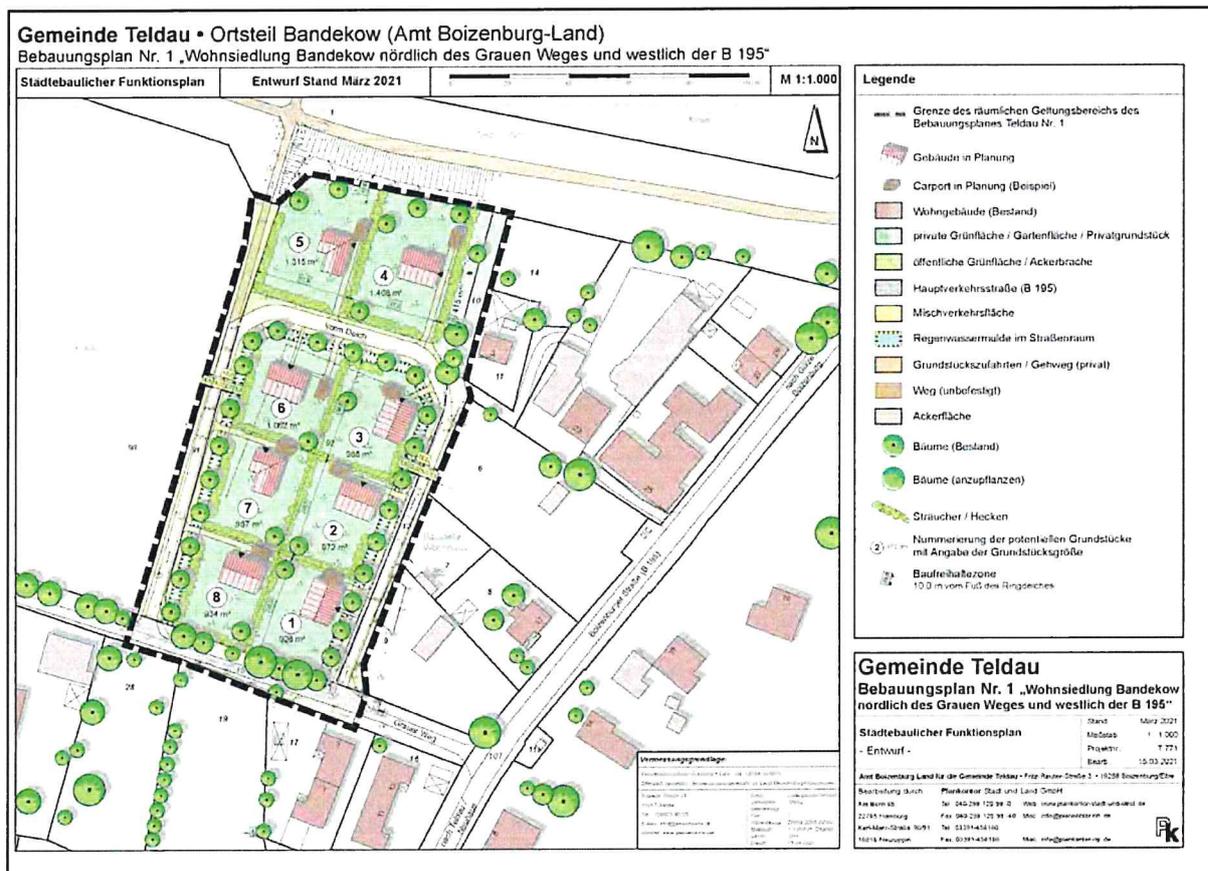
Städtebaulicher Funktionsplan zur Veranschaulichung des Vorhabens (Quelle: Plankontor Stadt und Land GmbH, März 2021)
